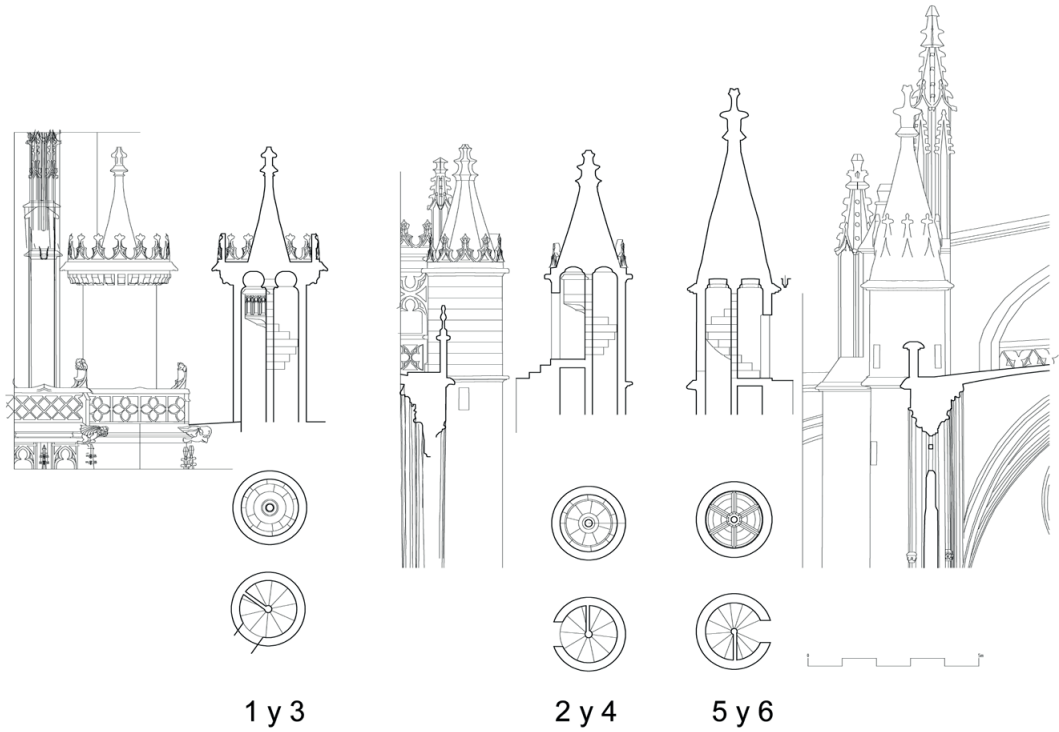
Alzados, secciones y plantas de las escaleras del primer grupo. El número es el ID de la tabla. (Dibujos del autor).
